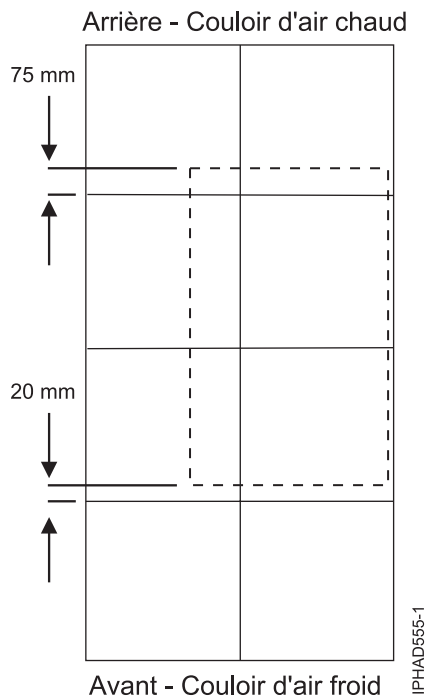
Positionnement de l'armoire pour dalles de plancher de 610 mm
